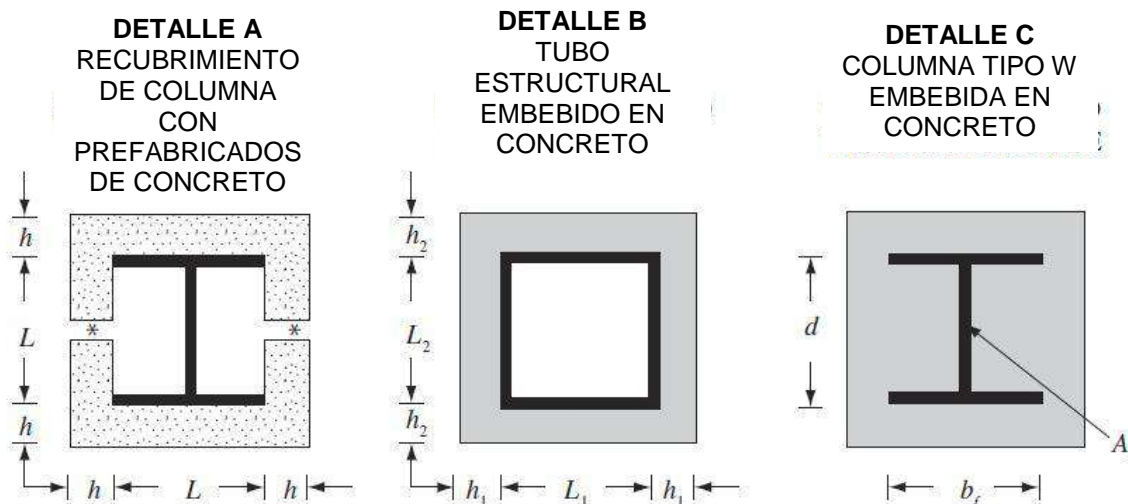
Columnas de acero estructural protegidas con concreto
